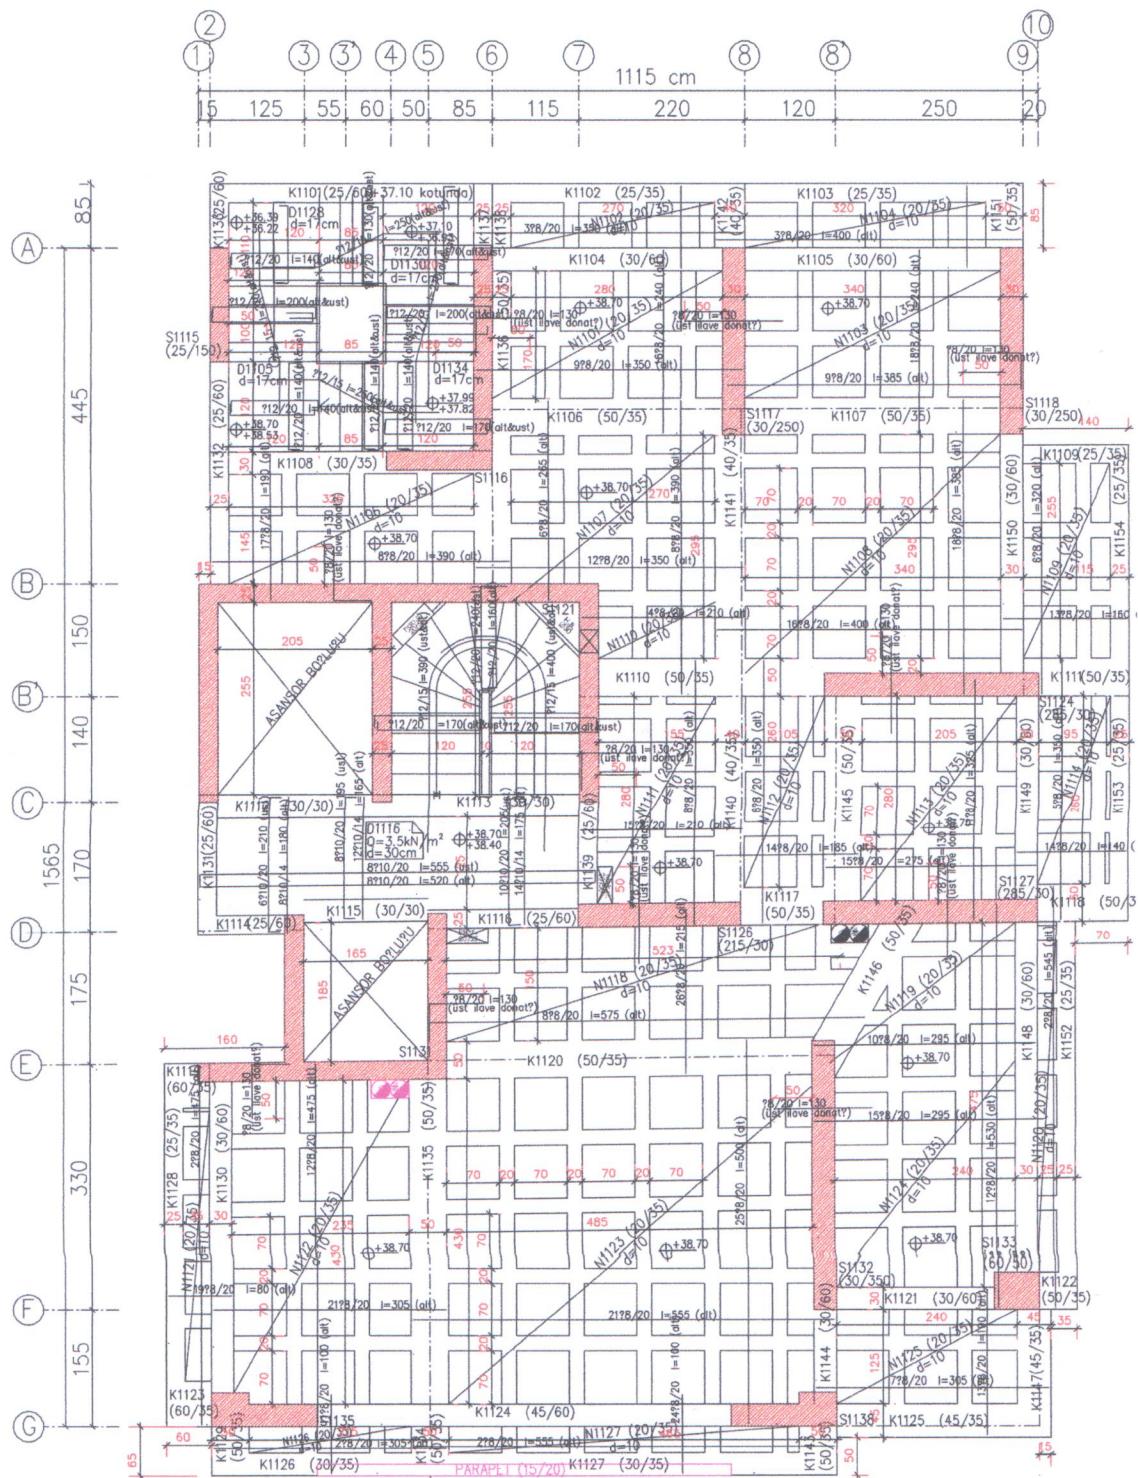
Fenerbahçe Konut Binası Bodrum Kat Kalıp Planı (+0.30m Kotu)
